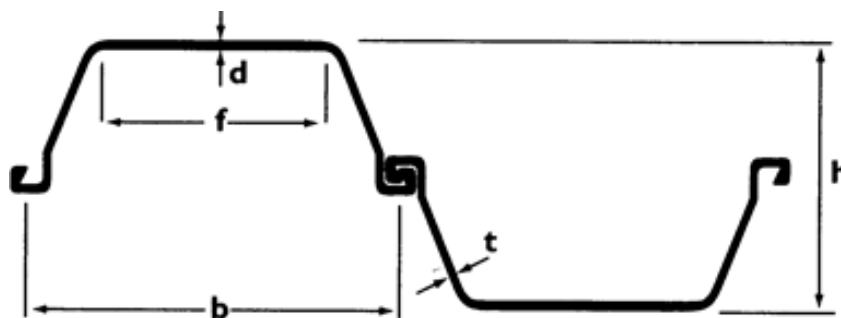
Geometria da parede – LARSSSEN 23 e 24.
